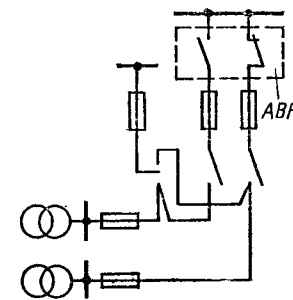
Схема электроснабжения жилого дома высотой 17 этажей и выше
